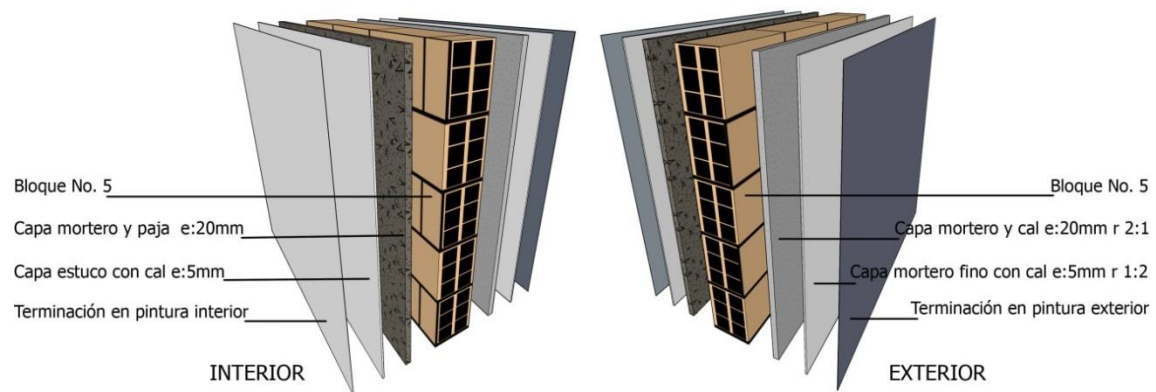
Imagen indicando las capas a aplicar en el interior y exterior del muro perimetral. . Elaboración propia 2017.
